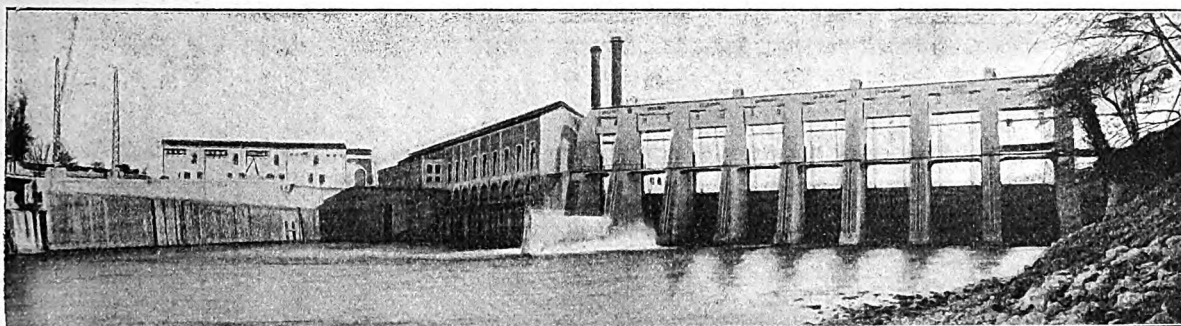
Vue générale du barrage et de l'usine, vue d'aval.
